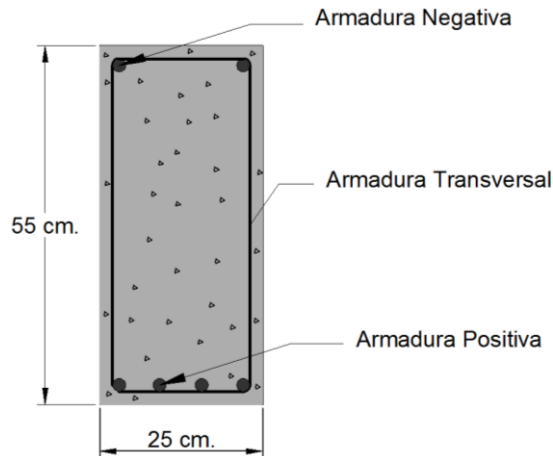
Dimensiones de la viga, Elaboración Propia
